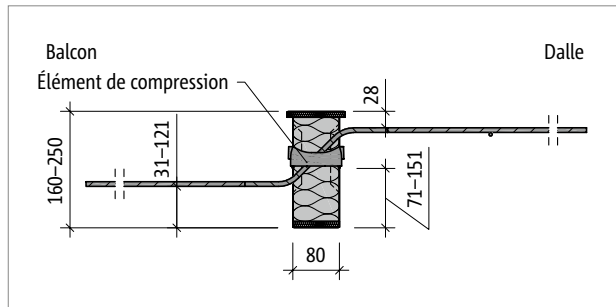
Schöck Isokorb® T type Q-E-V4 : coupe du produit
